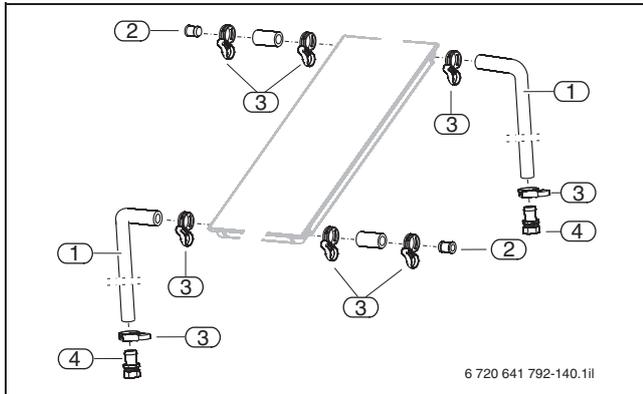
Set di collegamento Logasol CKN1.0 e SKN4.0 sopra tetto
